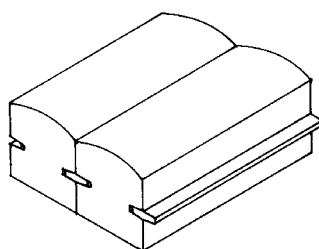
Stěna z prefabrikovaných tvarovek pro pasivní dům [1]
